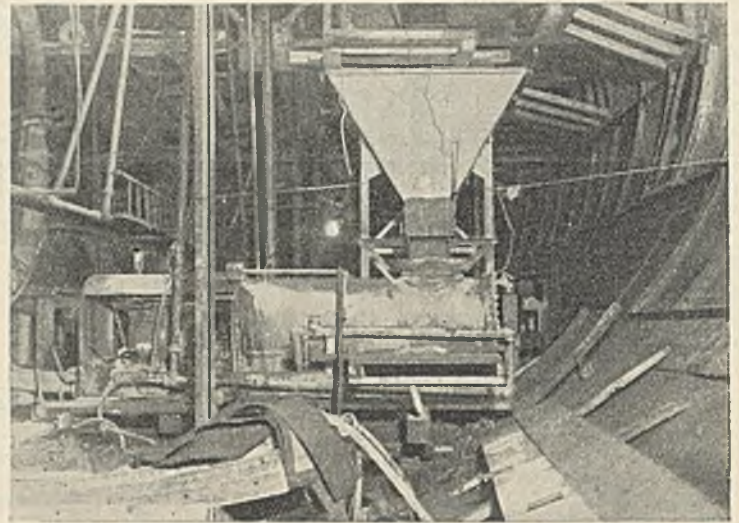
Betonieren des inneren Tunnelmantels. Der Beton wird durch Mannlöcher in den oberen Behälter geschüttet. Von dem darunterliegenden waagerechten Behälter wird er durch den links am Rande sichtbaren Schlauch mittels Motorkraft in die Schalung gedrückt.
